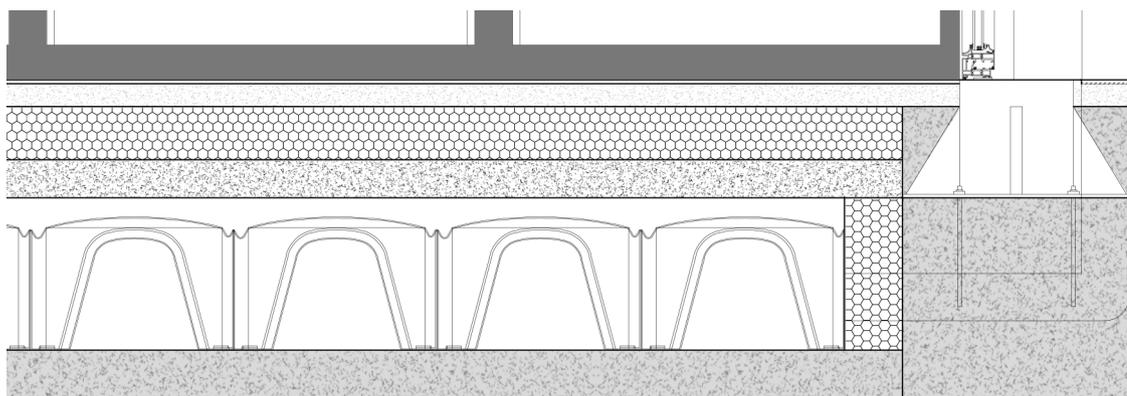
Estratto sezione prospettica nuova costruzione, estratto tavola 6 di progetto
